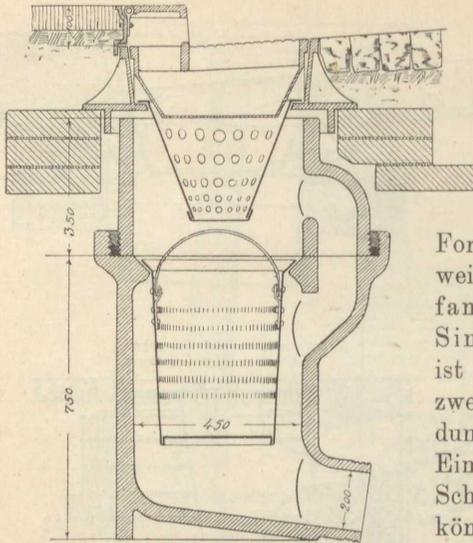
a. Sparsinkkasten (ohne Schlammfang und ohne Wasserverschluß) mit Laubeimer und Sandeimer.
